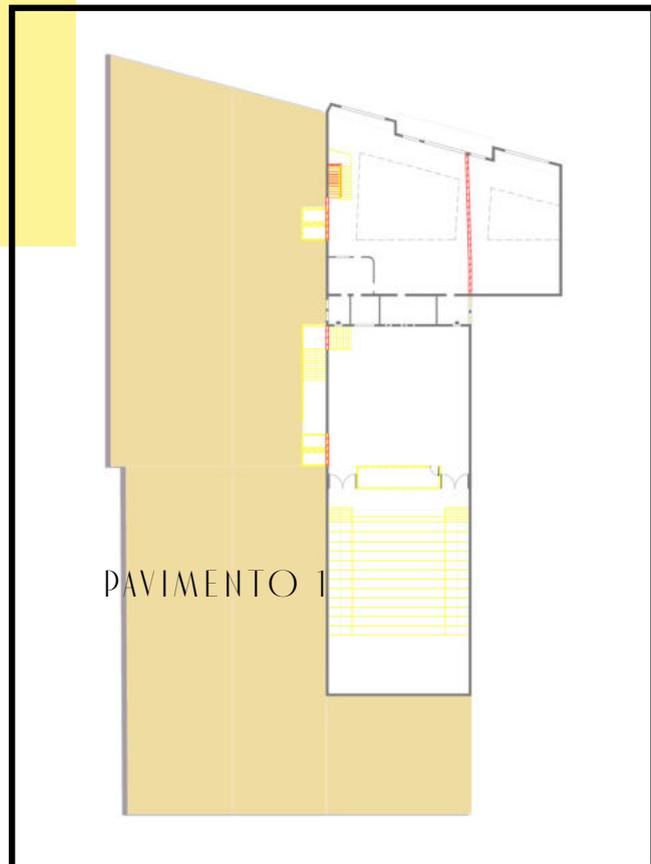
Planta térreo de demolição e construção do antigo cinema, sem escala. Fonte: Autoria própria.
